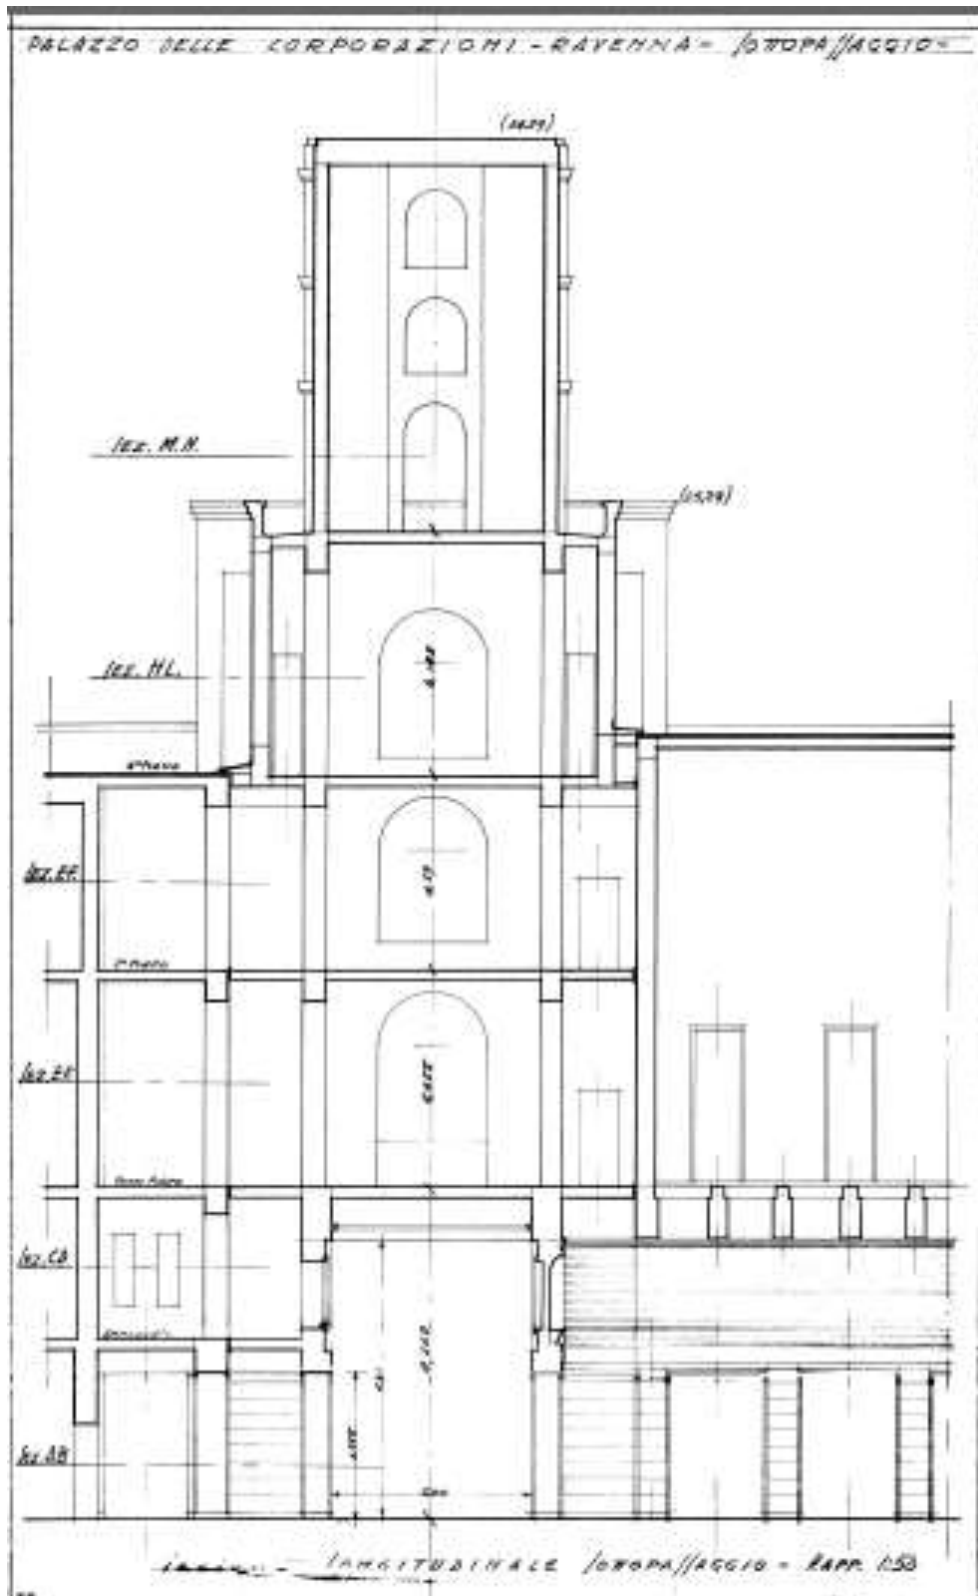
Sezione trasversale della torre su via Baccarini, con indicazione delle sezioni corrispondenti alle piante dei vari piani riportate in Figura 4.29 e 4.30 (progetto preliminare).
